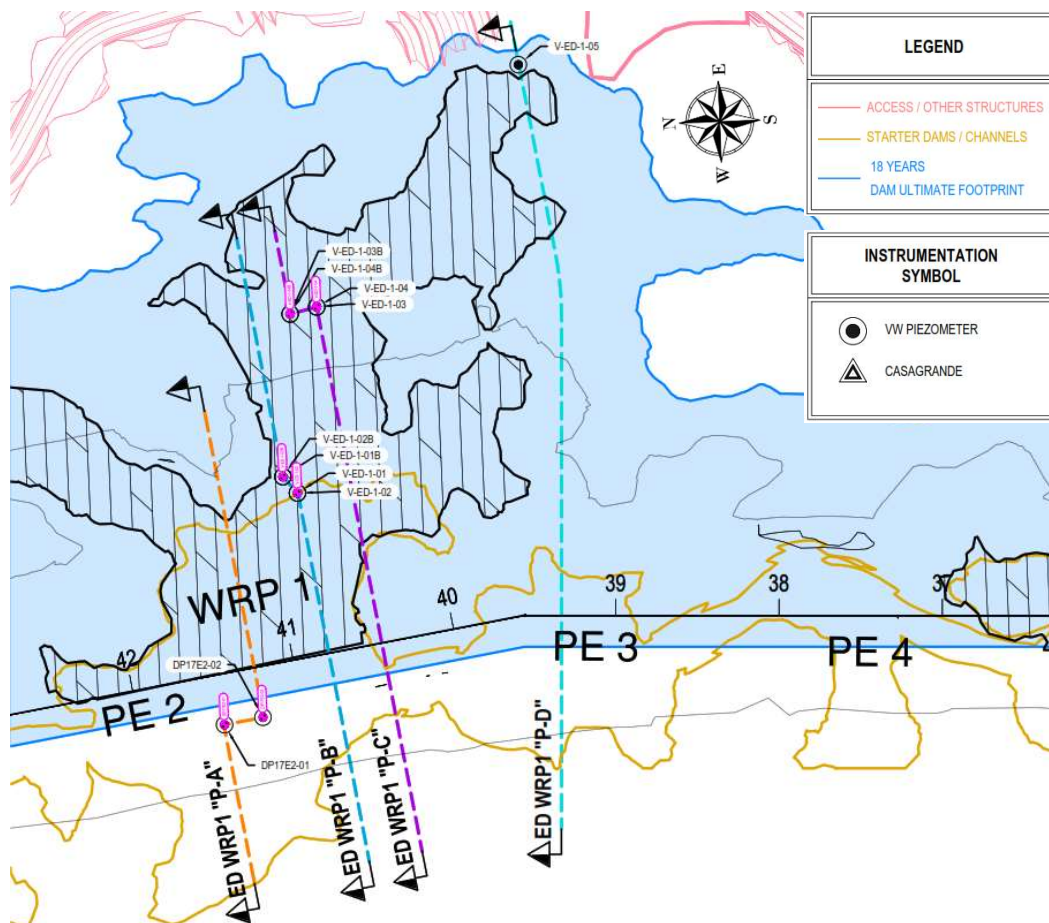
1: Vista en planta del PE WRP1 - Grupos de instrumentos Piezometro y Casagrande
